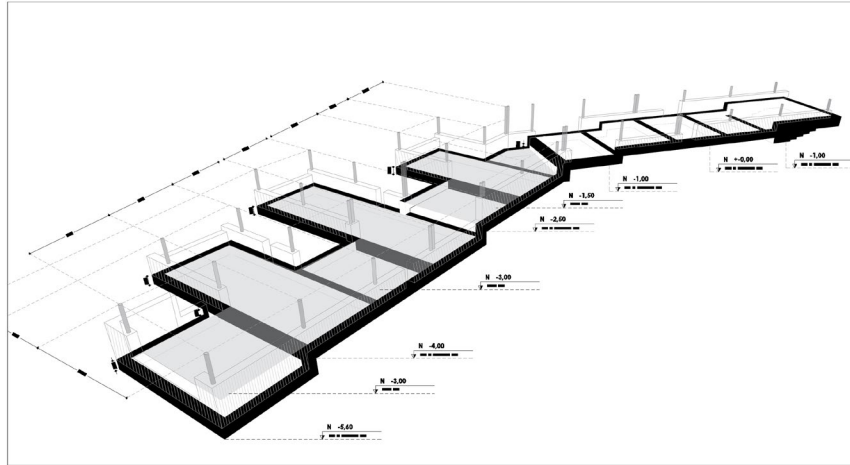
Modelo 3D de cimentación. Elaboración: (Pérez, 2018)
